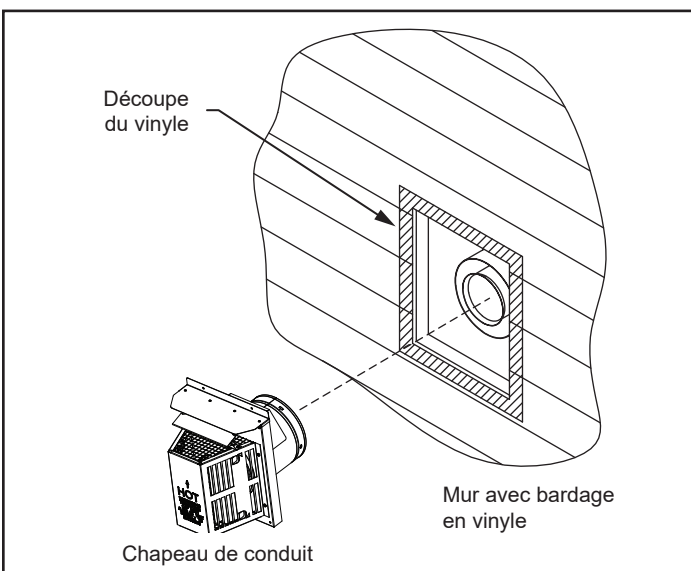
Chapeau de conduit horizontal sur un mur avec bardage en vinyle
